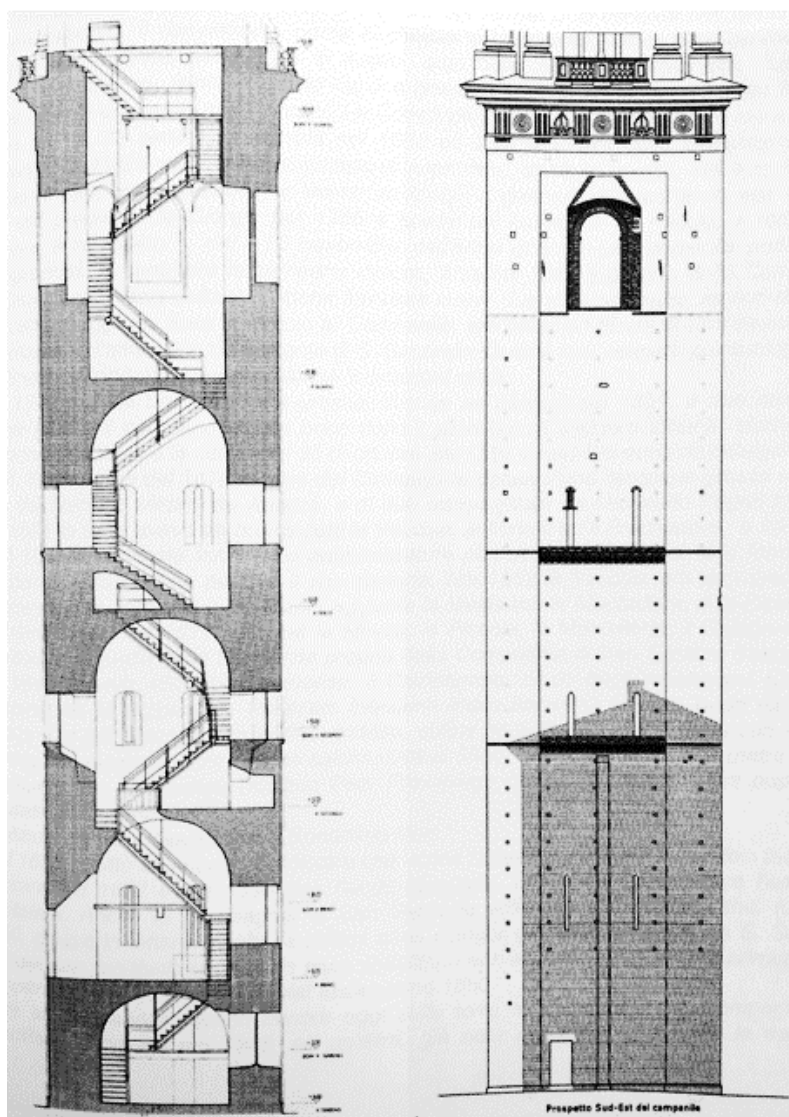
Sezione e Prospetto della parte Quattrocentesca del Campanile
